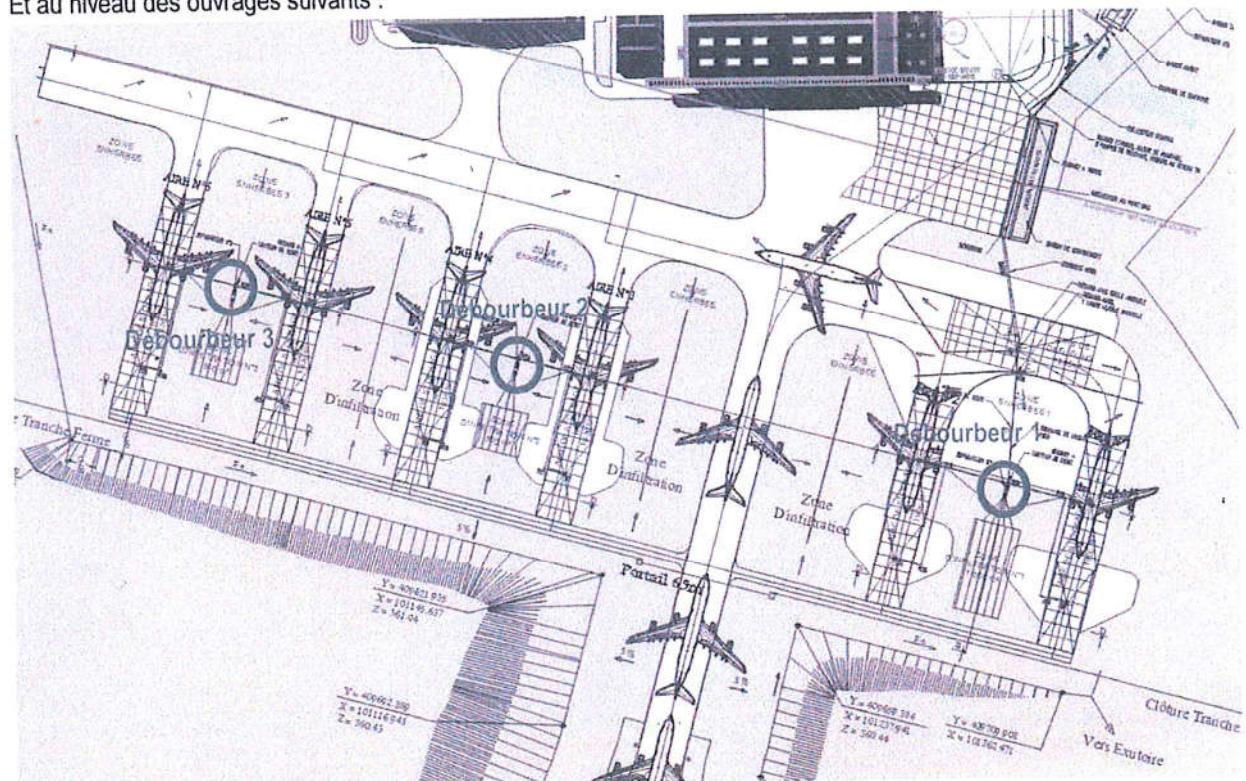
IMPLANTATION DES DÉBOURBEURS SUR LE SITE EXISTANT
